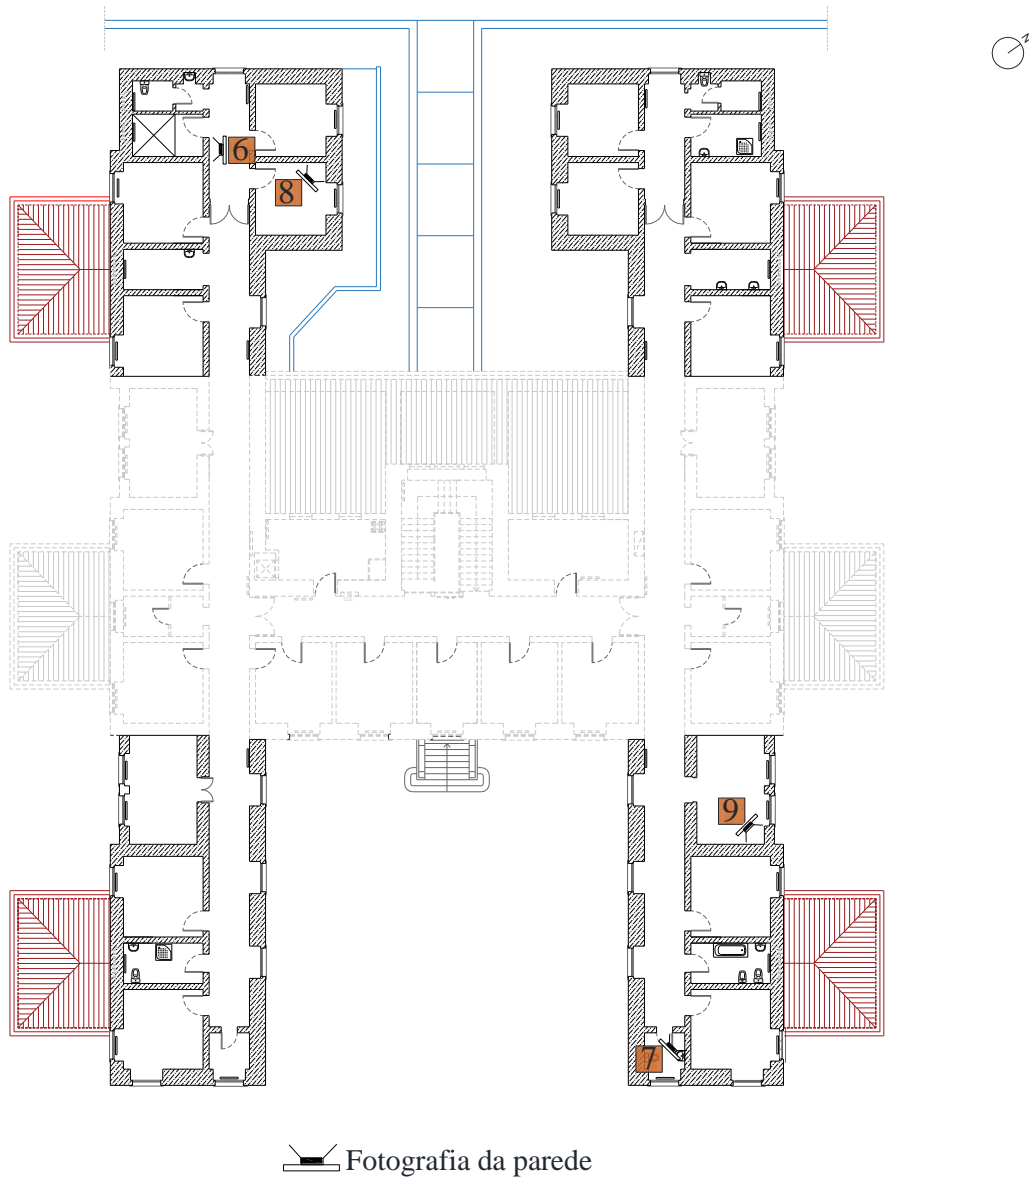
Identificação das Imagens , na planta do Piso 1 [Fonte: Planta cedida pelo C.H.J.M]
